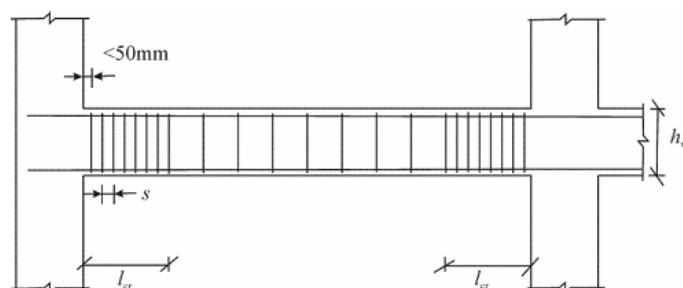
Armaduras transversais nas zonas críticas das vigas
